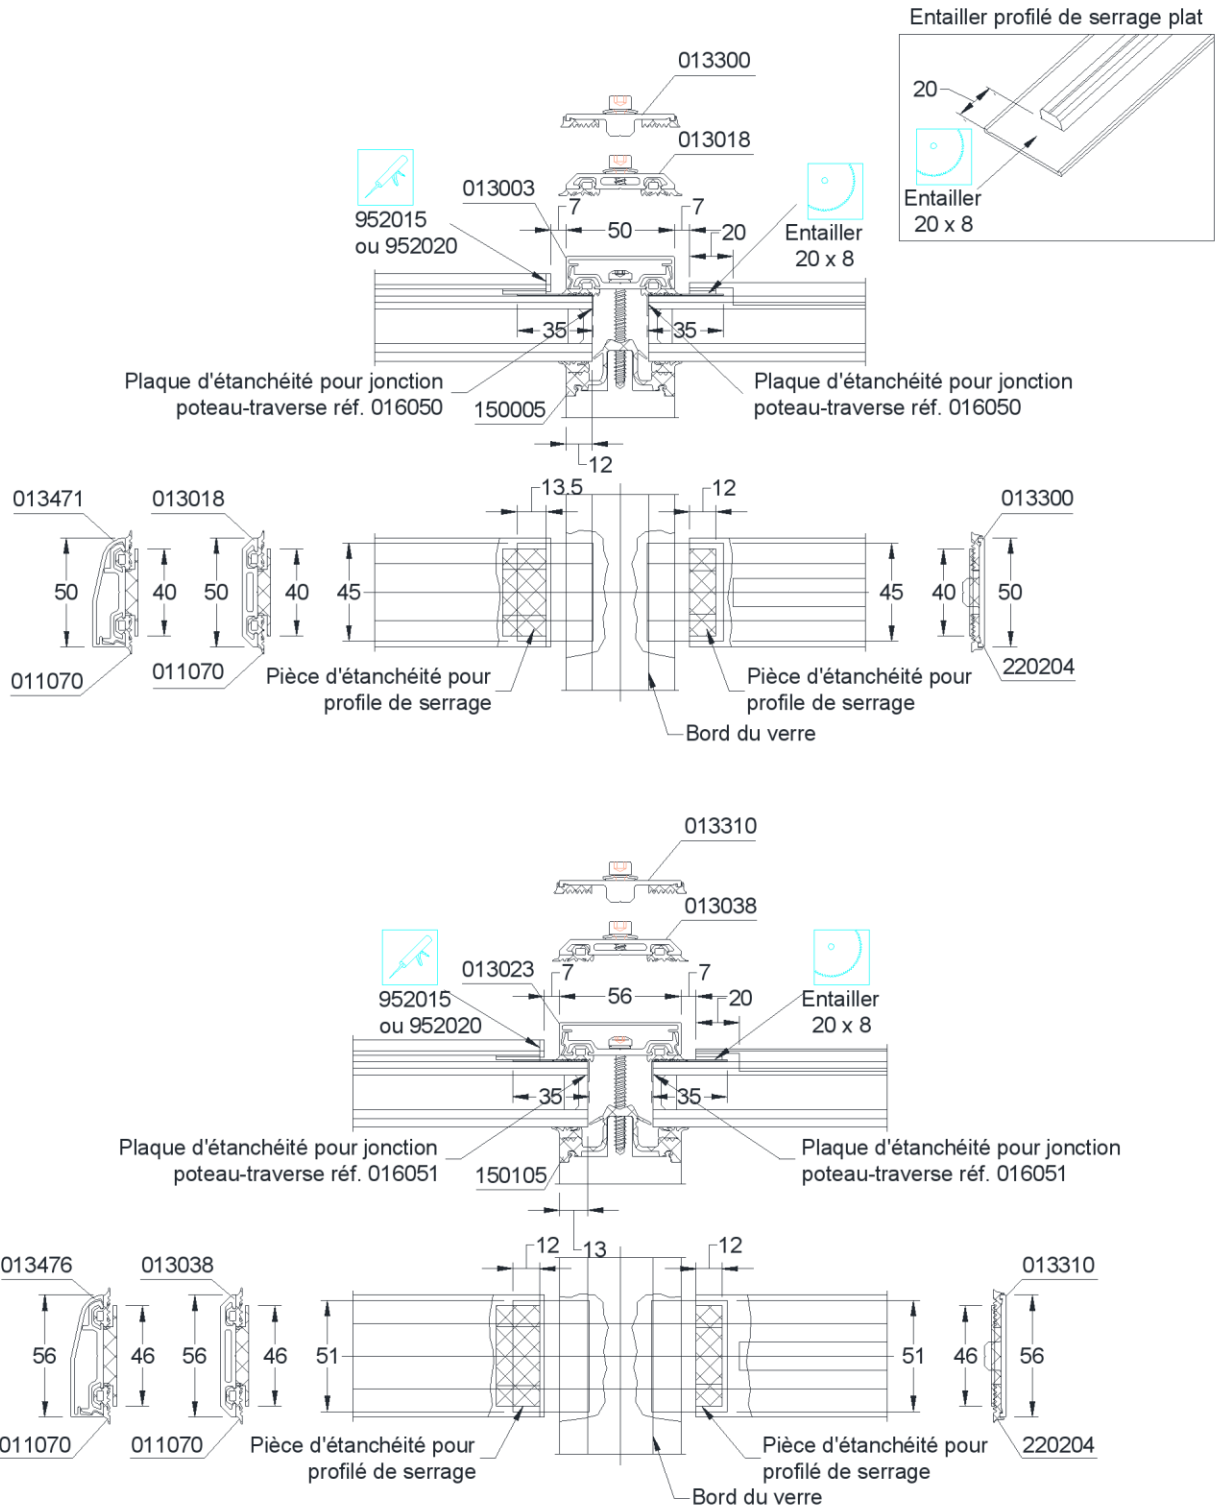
montage des plaques d'étanchéité de croisement et des pièces d'étanchéité de profilé de serrage
